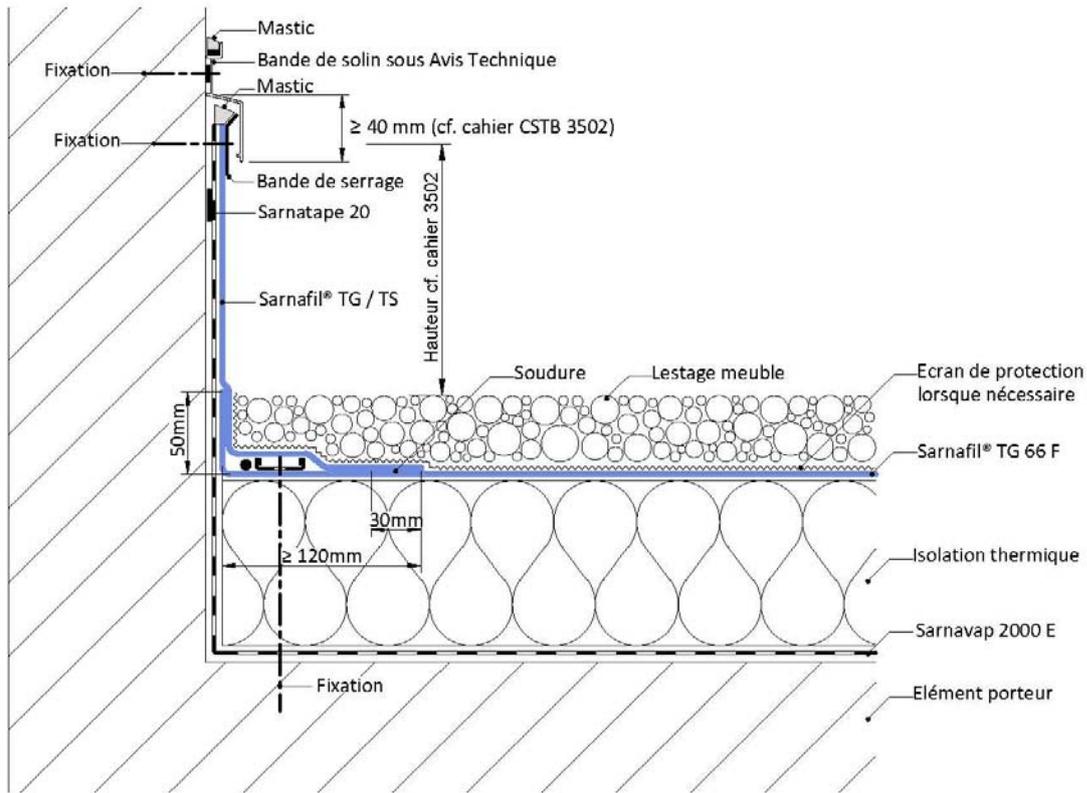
Relevé d'étanchéité sous engravure – Travaux de réfection sur maçonnerie
